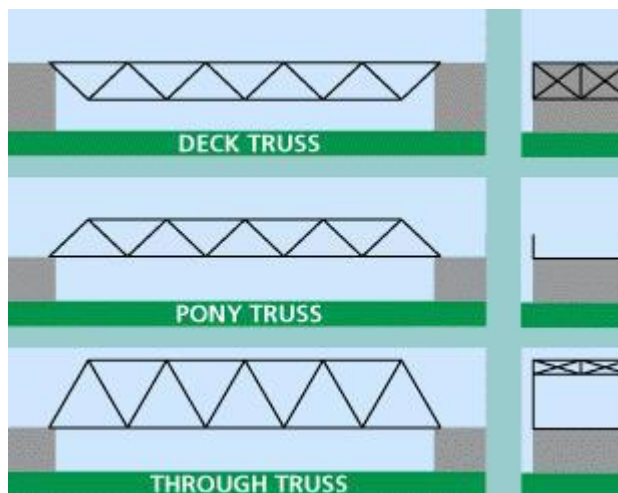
Schémas des ponts en poutres en treillis "Deck, Pony et Through"
